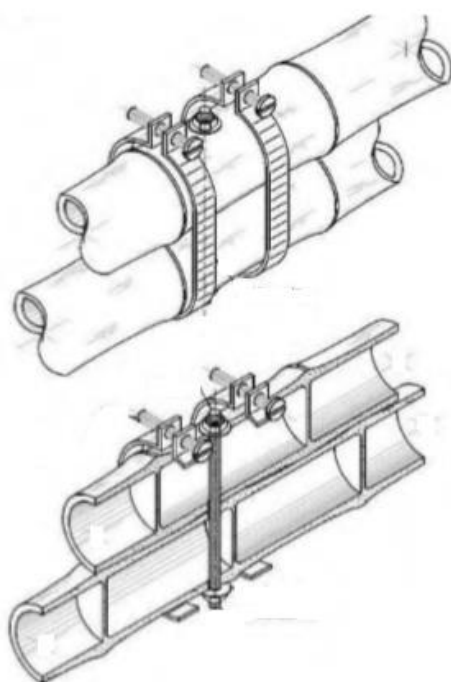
Abraçadeiras metálicas em estruturas de bambu. Fonte: Norma colombiana NSR-10 (2010).
